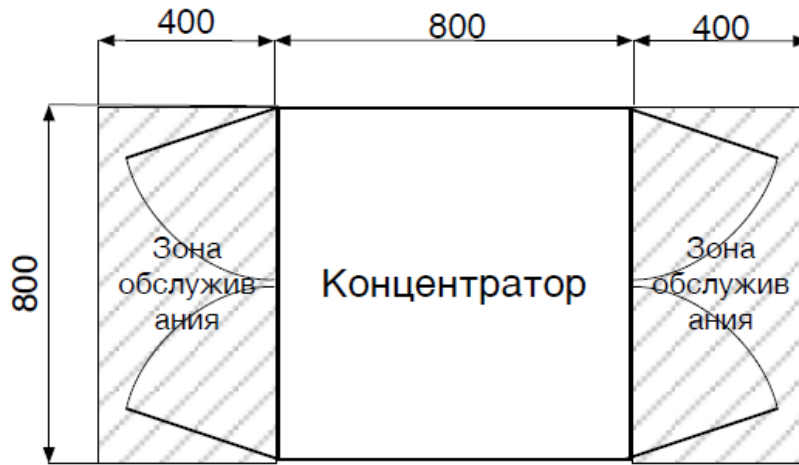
Внешний вид и габаритные размеры концентратора с двухстворчатыми дверями
